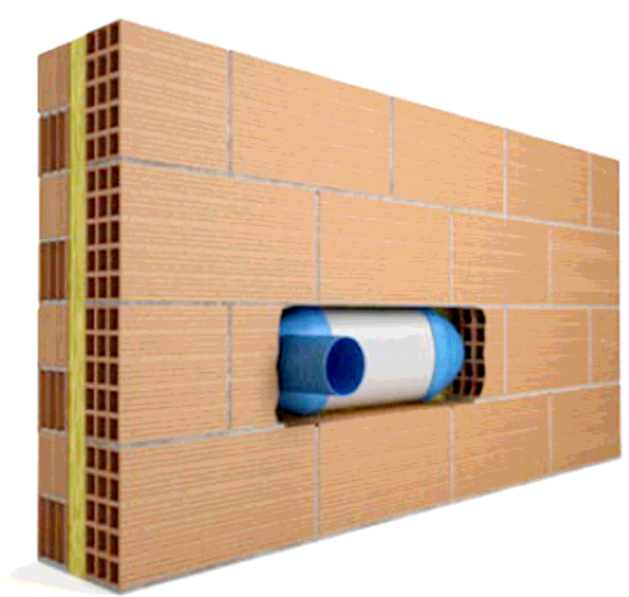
Schema di installazione della presa d'aria "Silentio" sulla parete di facciata.
